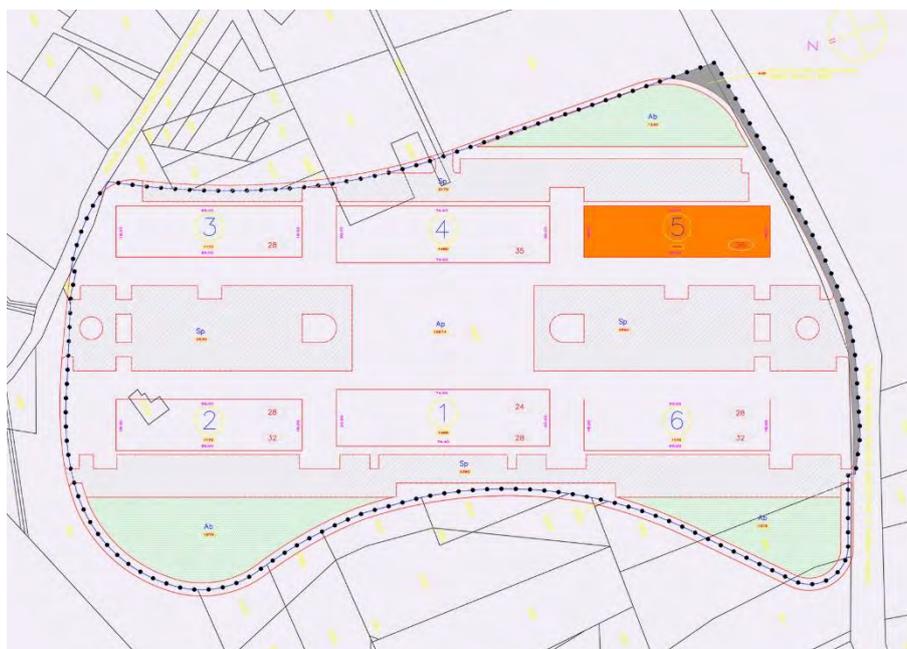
Individuazione del lotto sulla tavola "lottizzazione" di Piano Particolareggiato
